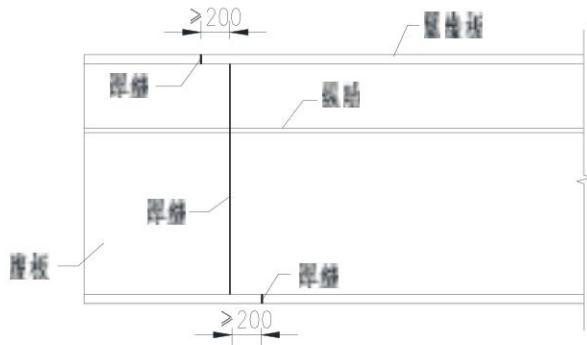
焊缝错开的最小距离 (尺寸单位: mm)
